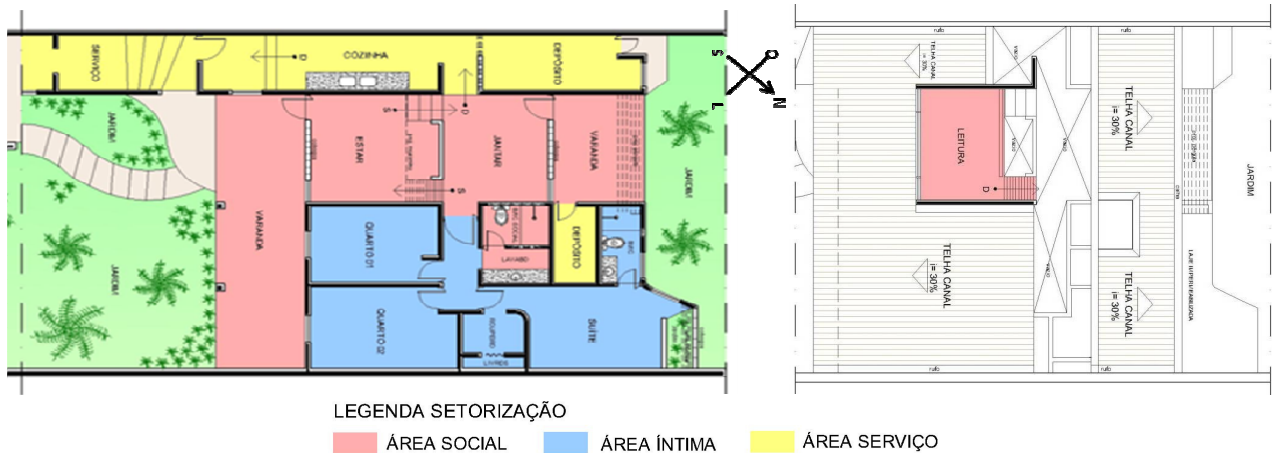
Planta Baixa Térreo e Planta Baixa Mezanino da casa avaliada, respectivamente.
